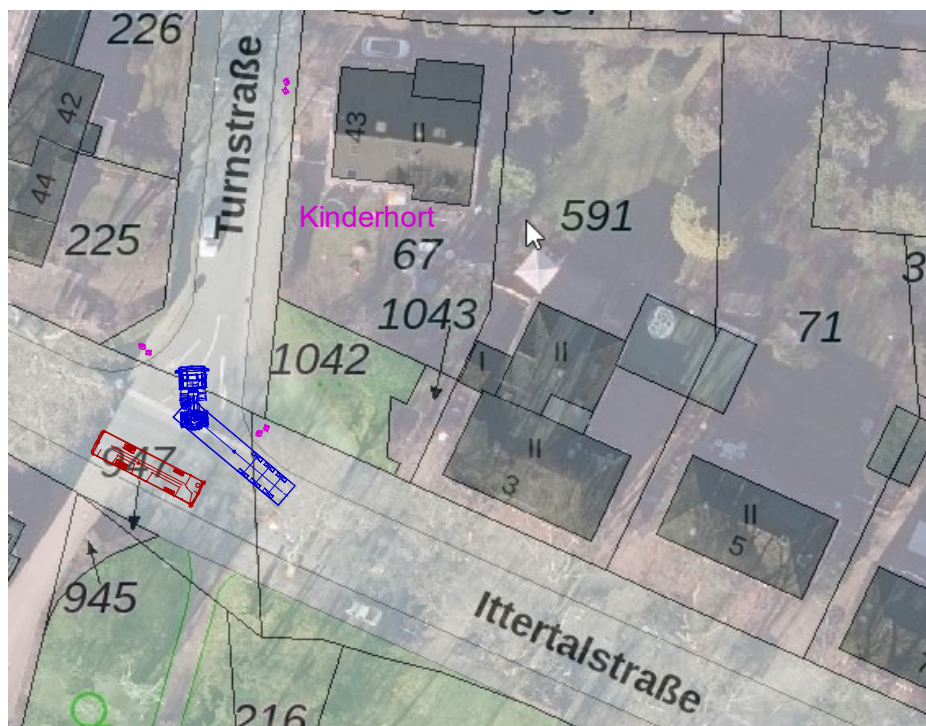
Fahrbahneigung im südlichen Straßenabschnitt der Turnstraße
